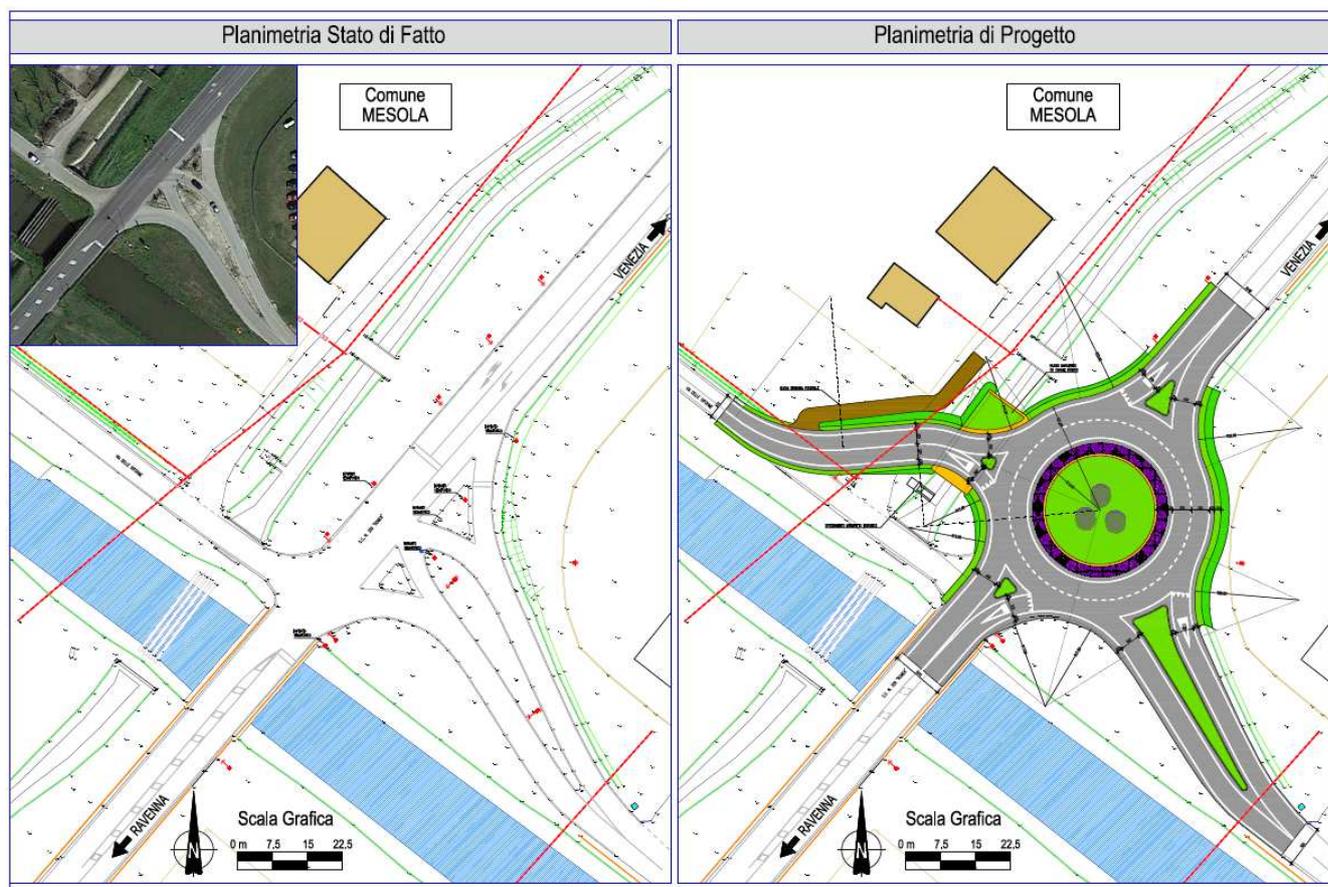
Intervento n° 19 – Planimetria Stato di fatto - Progetto
